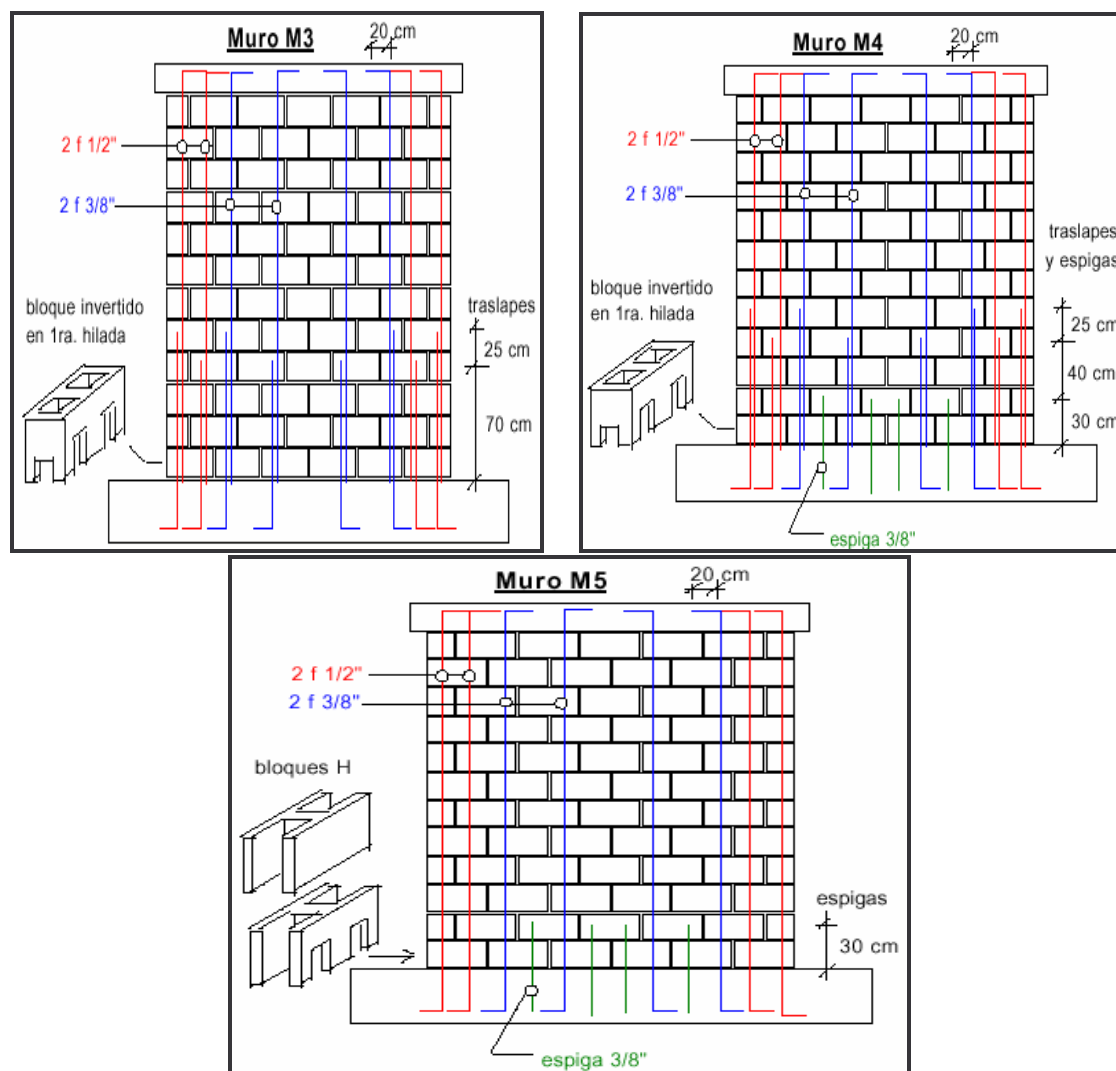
Refuerzo vertical, bloque de la primera hilada y espigas adicionales en M3, M4 y M5.
